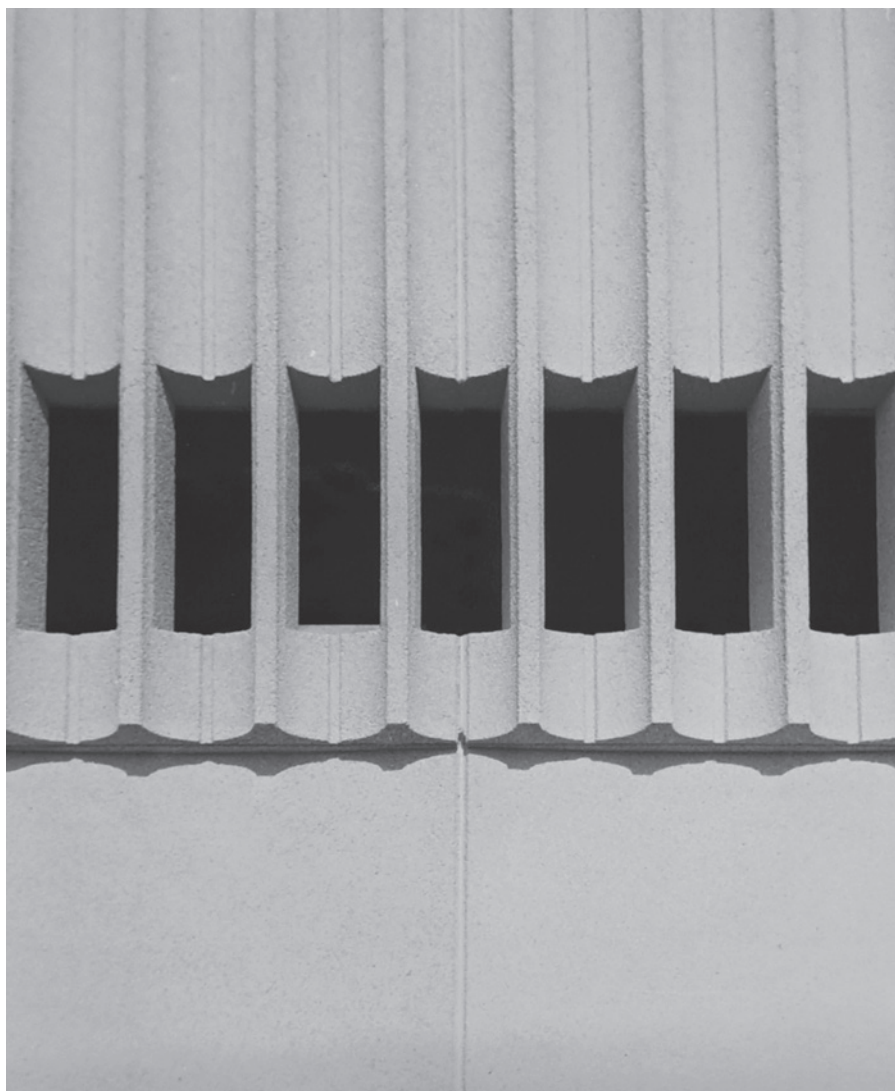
Dettaglio di prospetto (ASF, b. 46)
